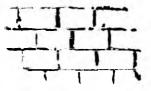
Кирпичная кладка подь столбами этажерокъ въ Саксенгаузенскомъ плодохранилицѣ.
